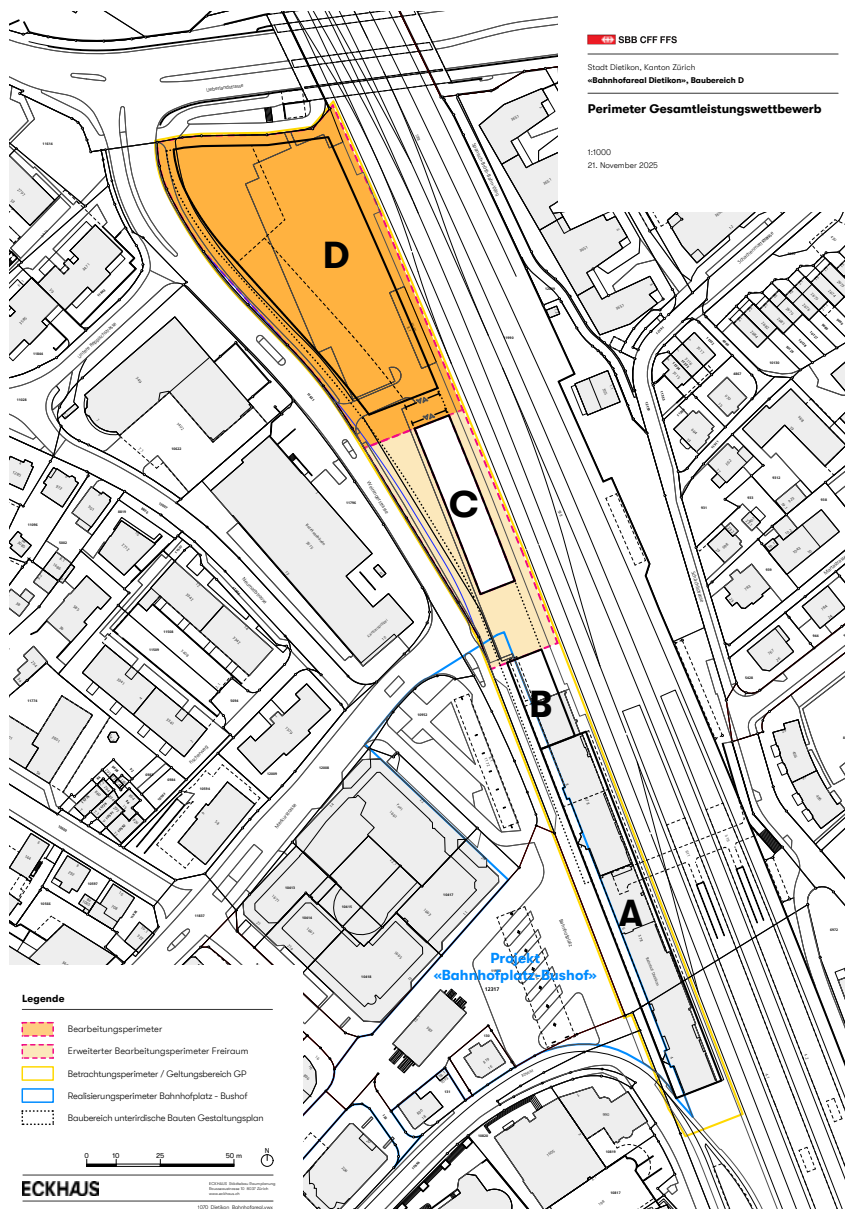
Perimeter Gesamtleistungsstudie, Situationsplan 1:1000 (verkleinerte Darstellung)
